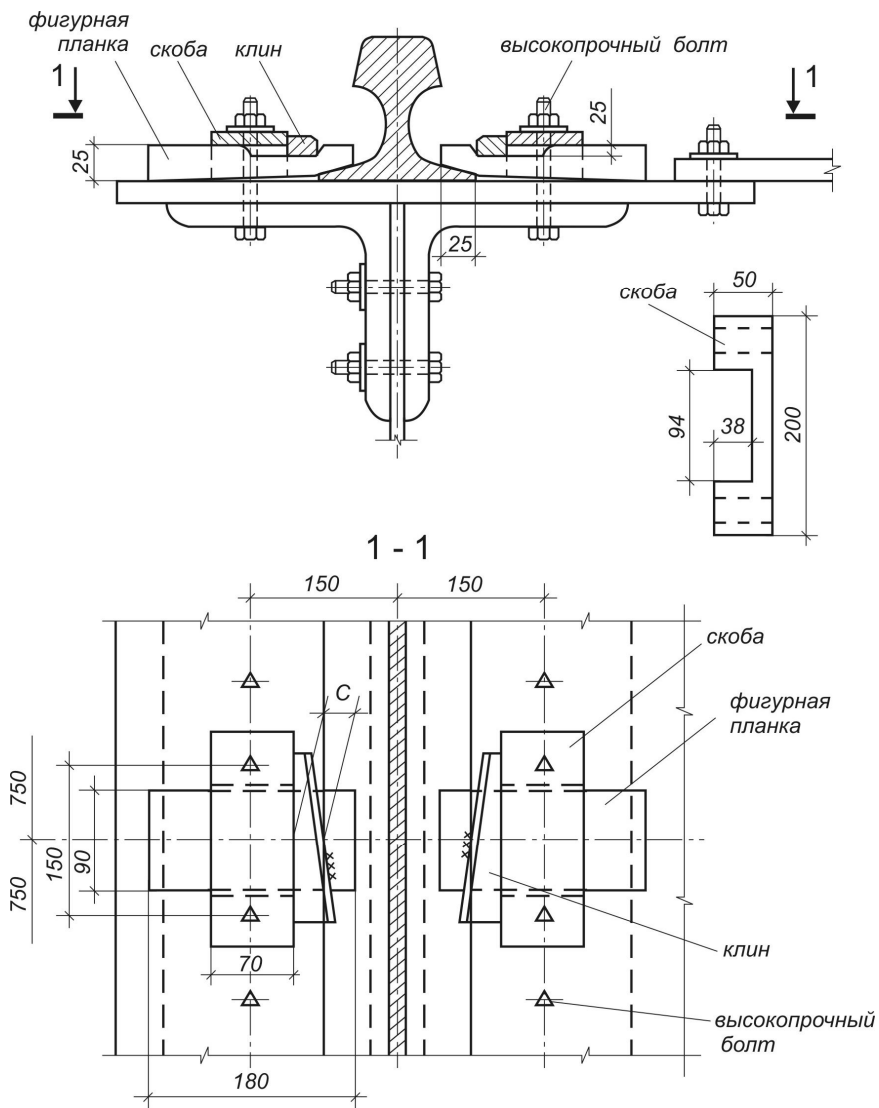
Крепление кранового рельса планками к верхнему поясу подкрановой балки
